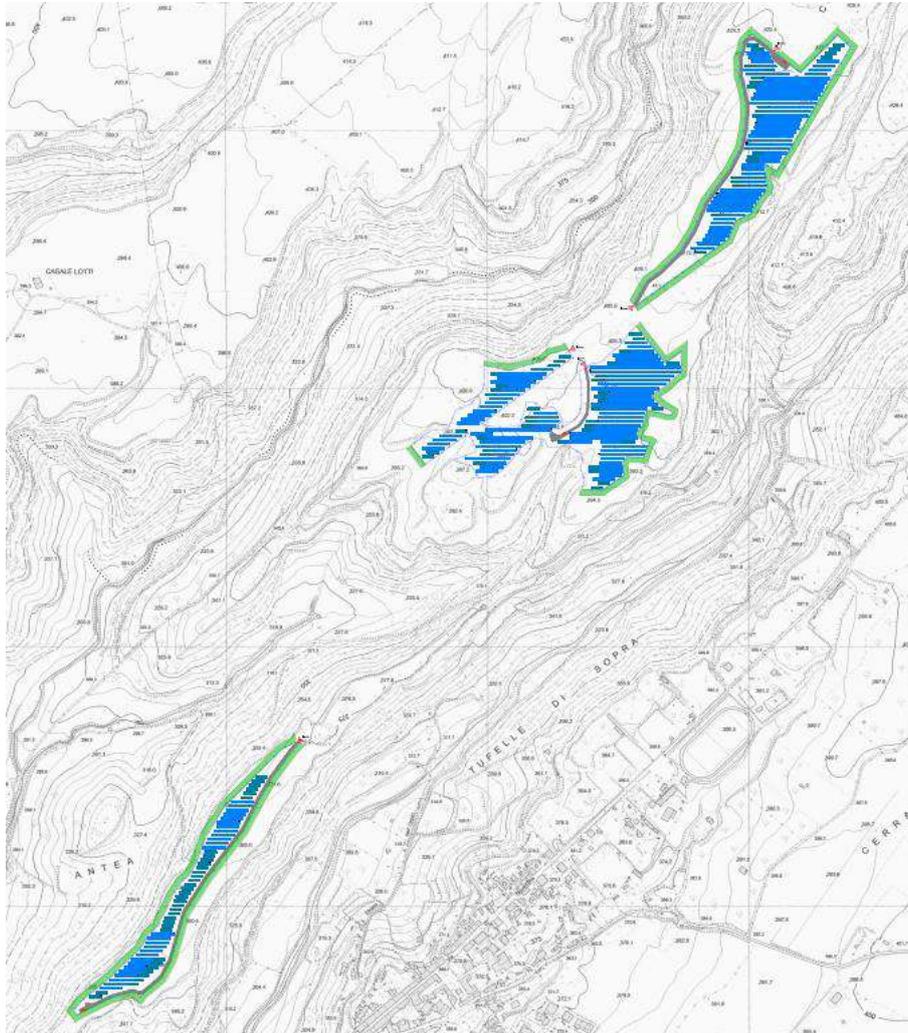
Layout impianto fotovoltaico – Aree D, E e F
